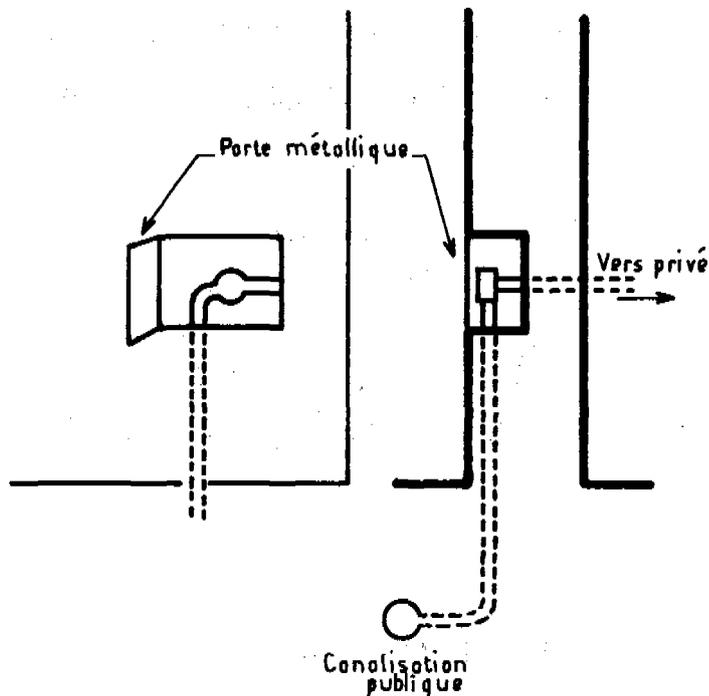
SCHEMA TYPE D'UN BRANCHEMENT PARTICULIER
